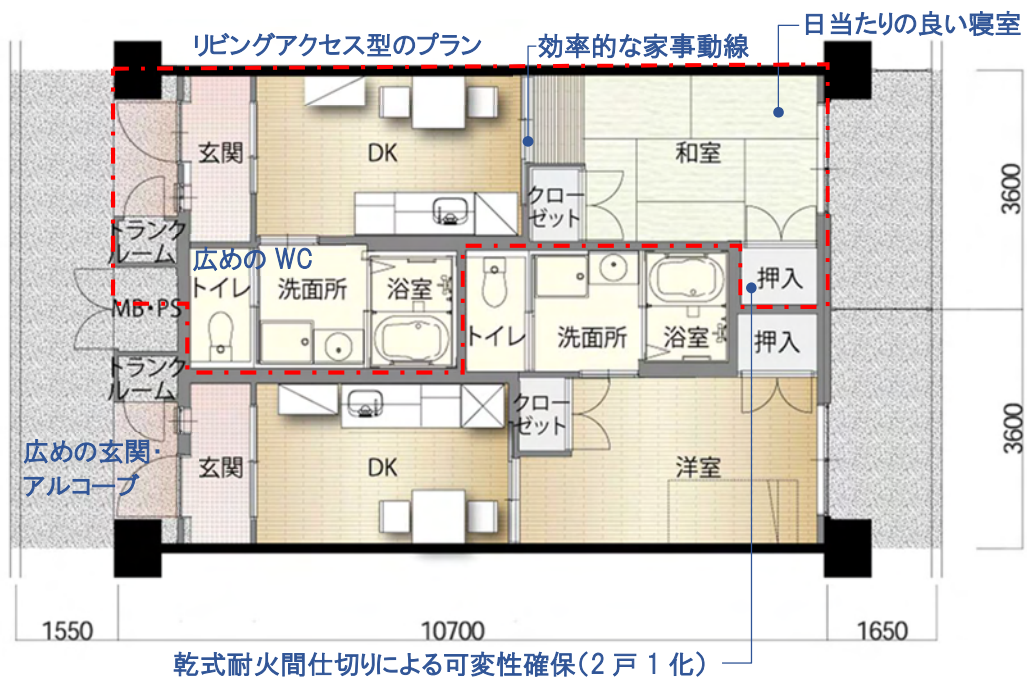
1DK\_PLAN 約35㎡(1人世帯用)
